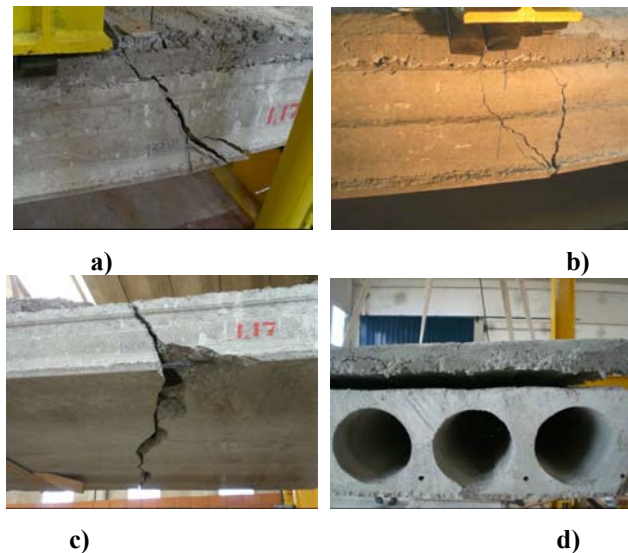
Configuração da fissuração da laje L17-CC-7_C: a) Fissuração da lateral da laje (lado esquerdo); c) Fissuração da lateral da laje (lado direito); d) Fissuração da parte inferior da laje; e) Descolamento da capa.
